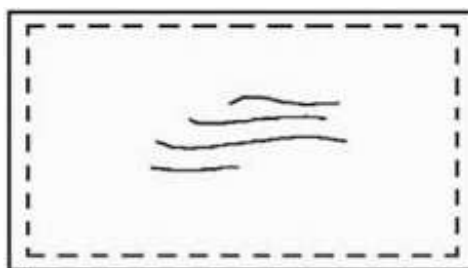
Fissuras na face inferior da laje, provocadas por momentos volventes
